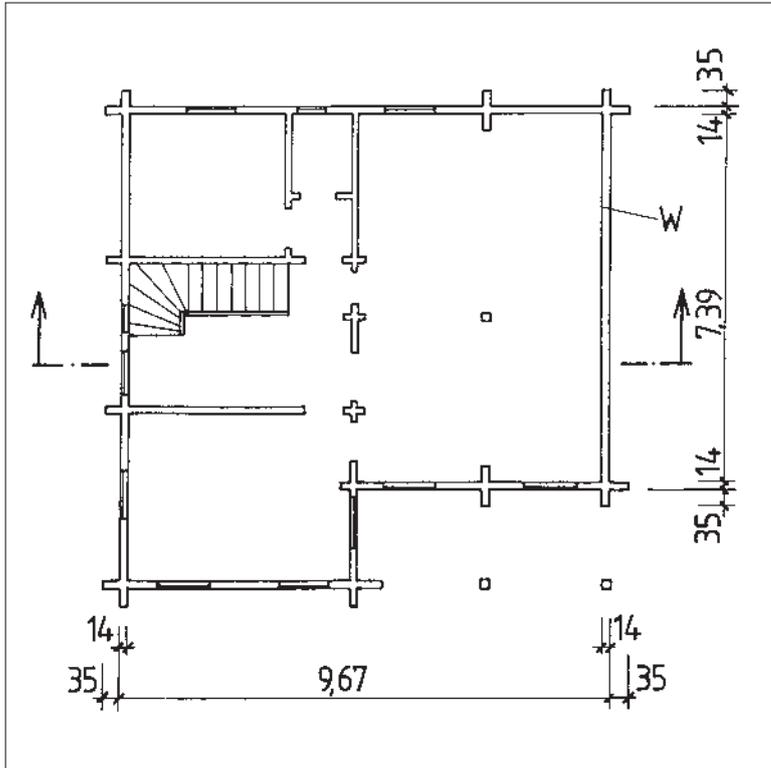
Erdgeschoßgrundriß des Blockhauses
